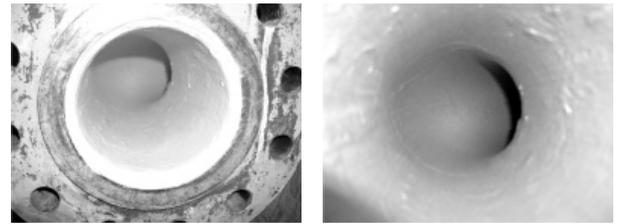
ライニング施工後の配管内面状態 — ライニング材料で経年配管の内面を保護している。
